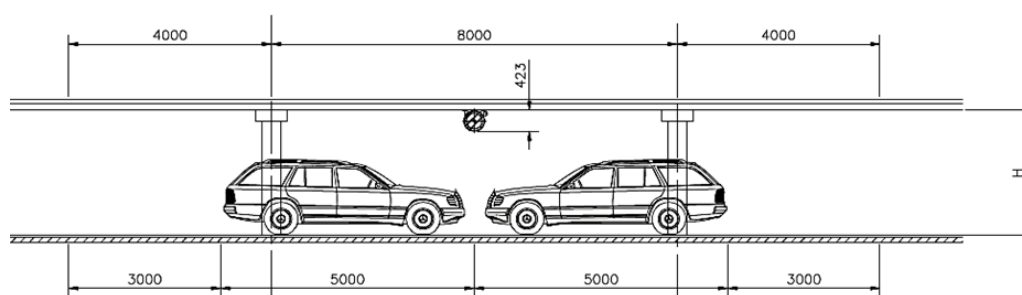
Расположение автомашин боком к вентиляционному воздушному потоку и струйных вентиляторов над парковочными местами
